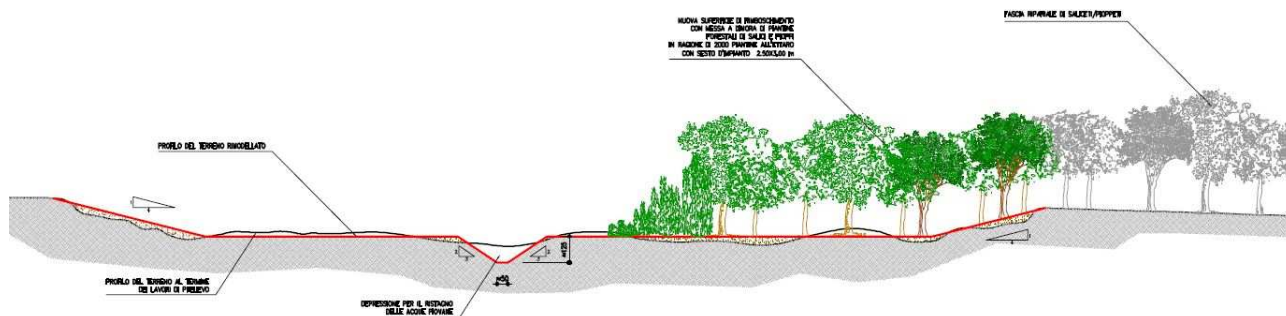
Interventi di rinaturalizzazione dell'area di escavazione – sezione tipologica
